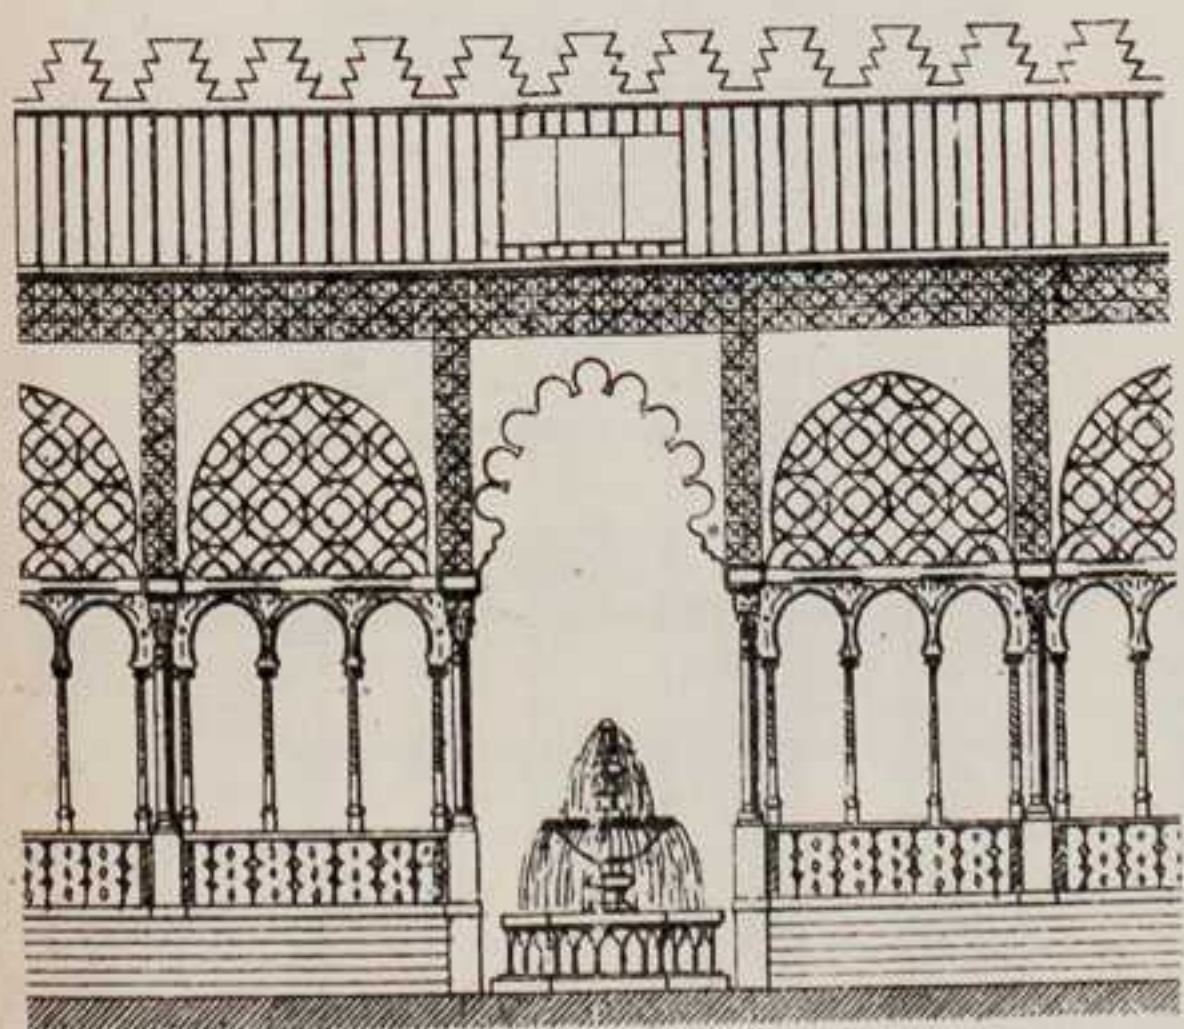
Prospetto interno della porta sul mezzo delle gallerie longitudinali. Scala di 0<sup>m</sup> 008.
